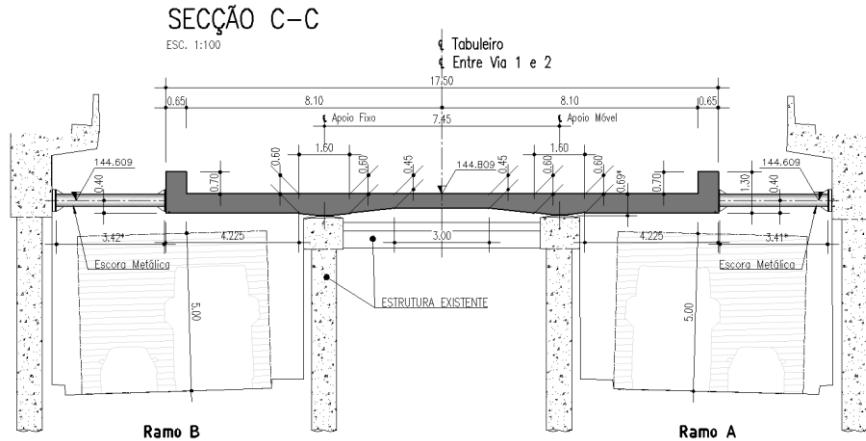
Secção transversal da Via de Resguardo em Trincheira na zona das escoras metálicas
